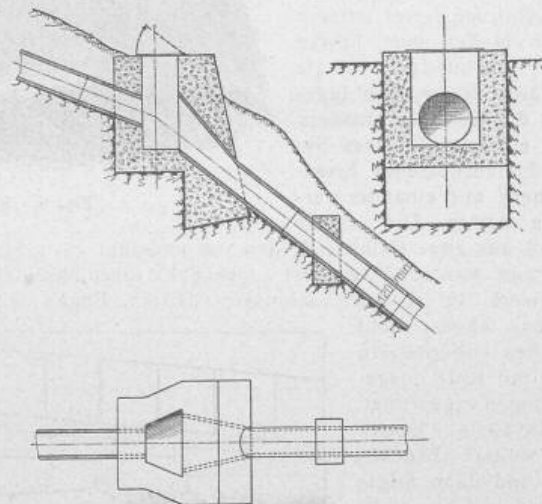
11. Grundriss und Schnitte der Ueberfall-Leitung mit Betonmassiv. 1:150.
